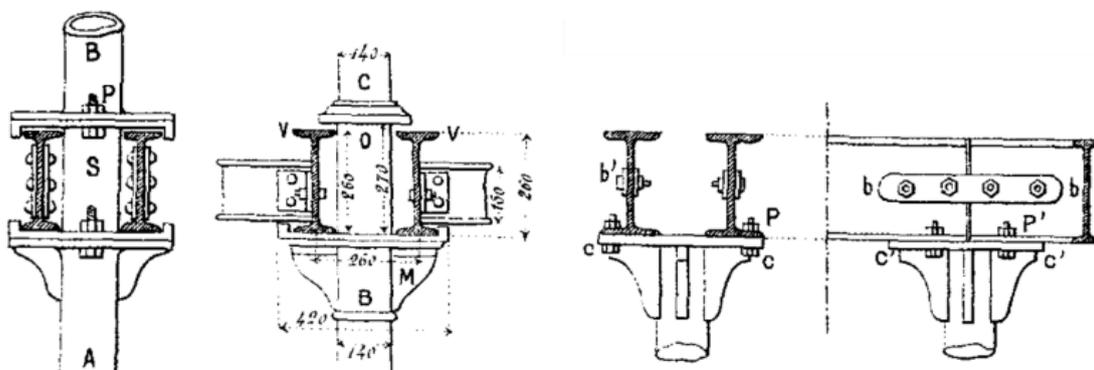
Diferentes soluciones constructivas de apoyo de vigas en columnas.
